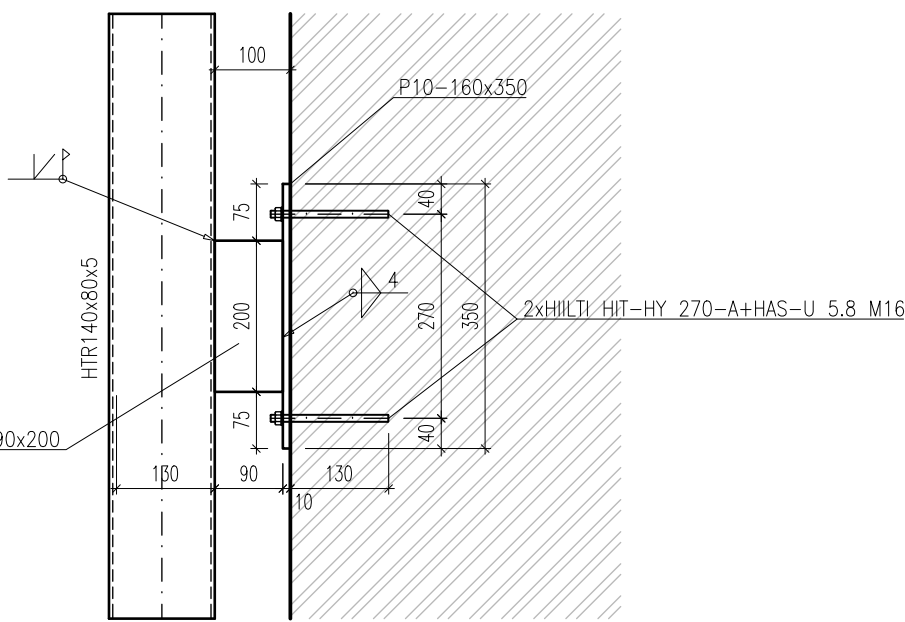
DETAIL A - DETAIL BOČNÍHO KOTVENÍ DO ZDIVA M 1:10
